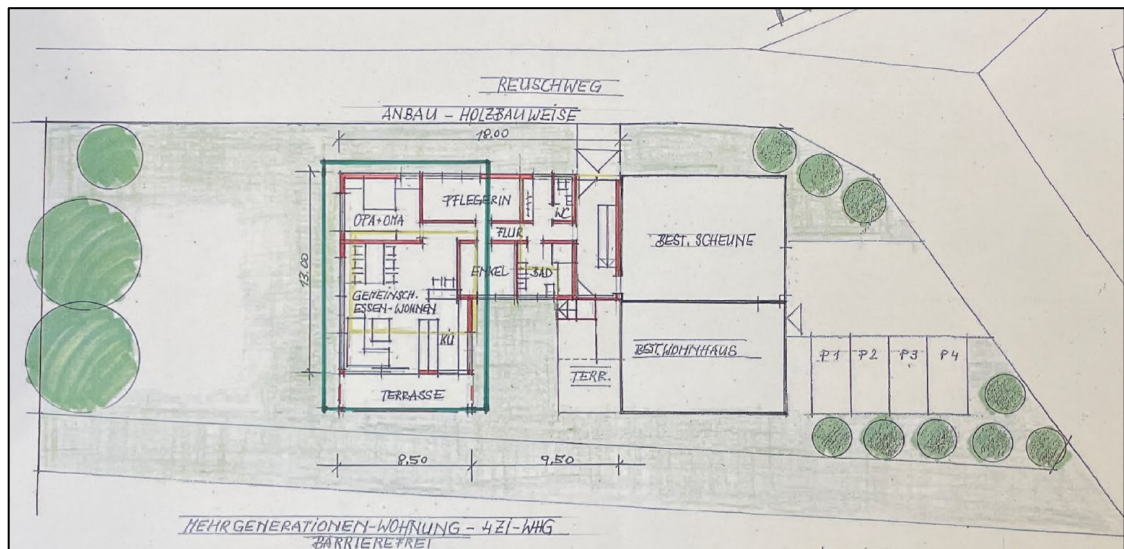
Anbau von zwei Mehrgenerationenwohnungen an bestehendes Wohnhaus, Grundriss Erdgeschoss, Entwurf: Architekturbüro Rainer Cee (2023), ohne Maßstab
